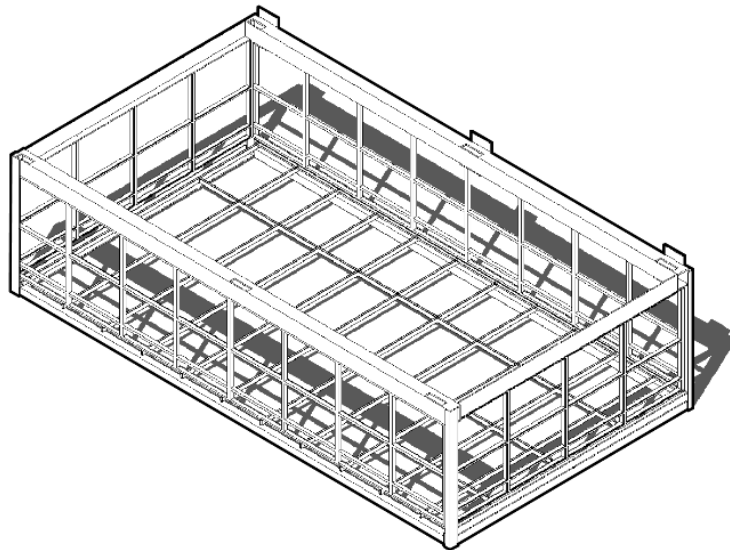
Sistema de estructura del módulo, elaboración propia (2020)
